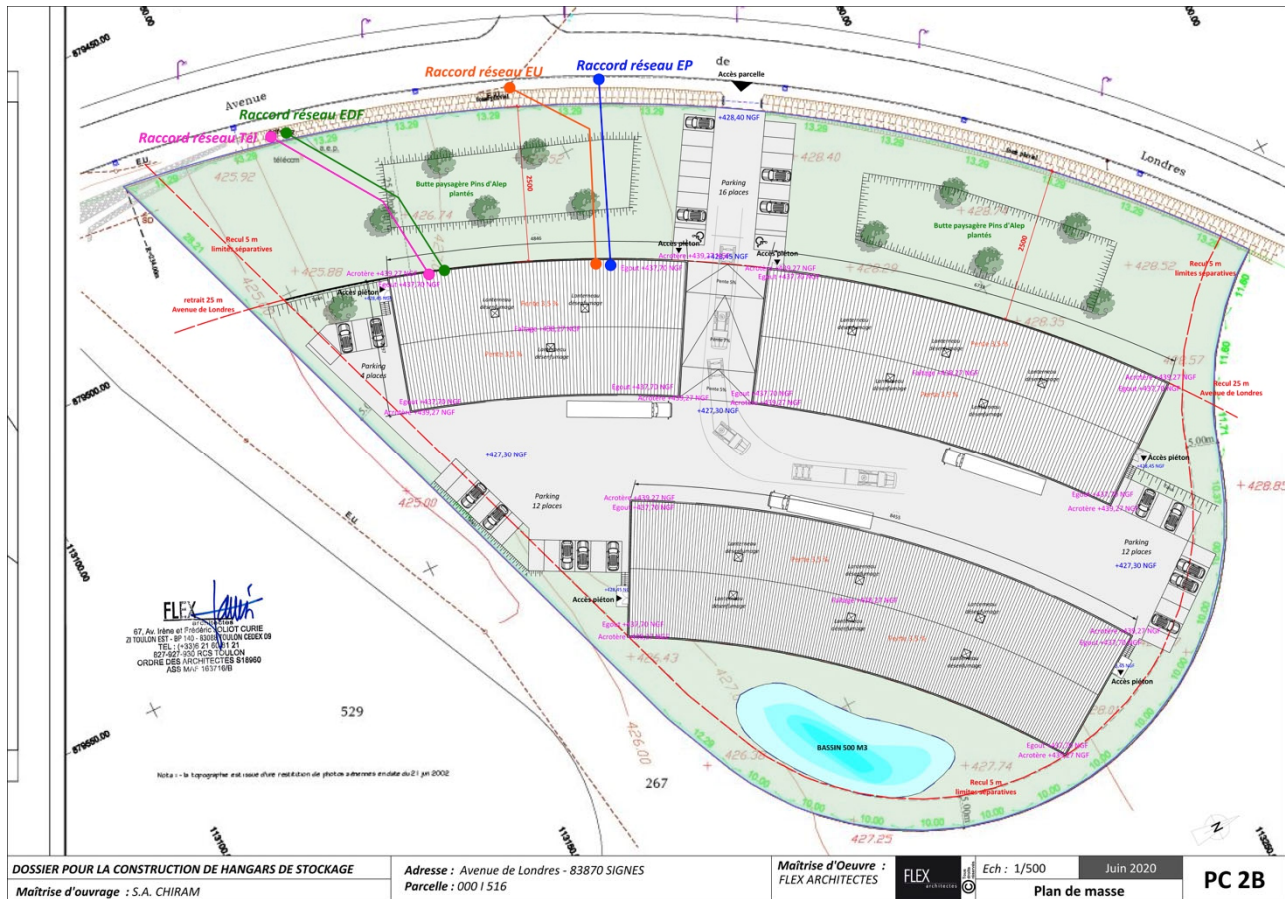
Plan masse du projet d'aménagement (source : FLEX Architectes).
